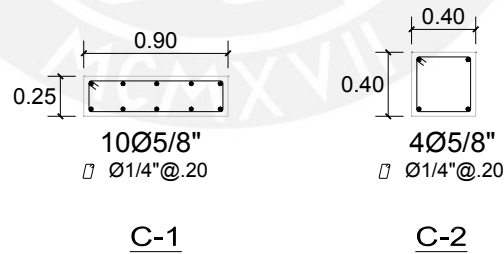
Detalle de columnas de concreto armado (Edificio de educación superior pre NDSR-1997)
